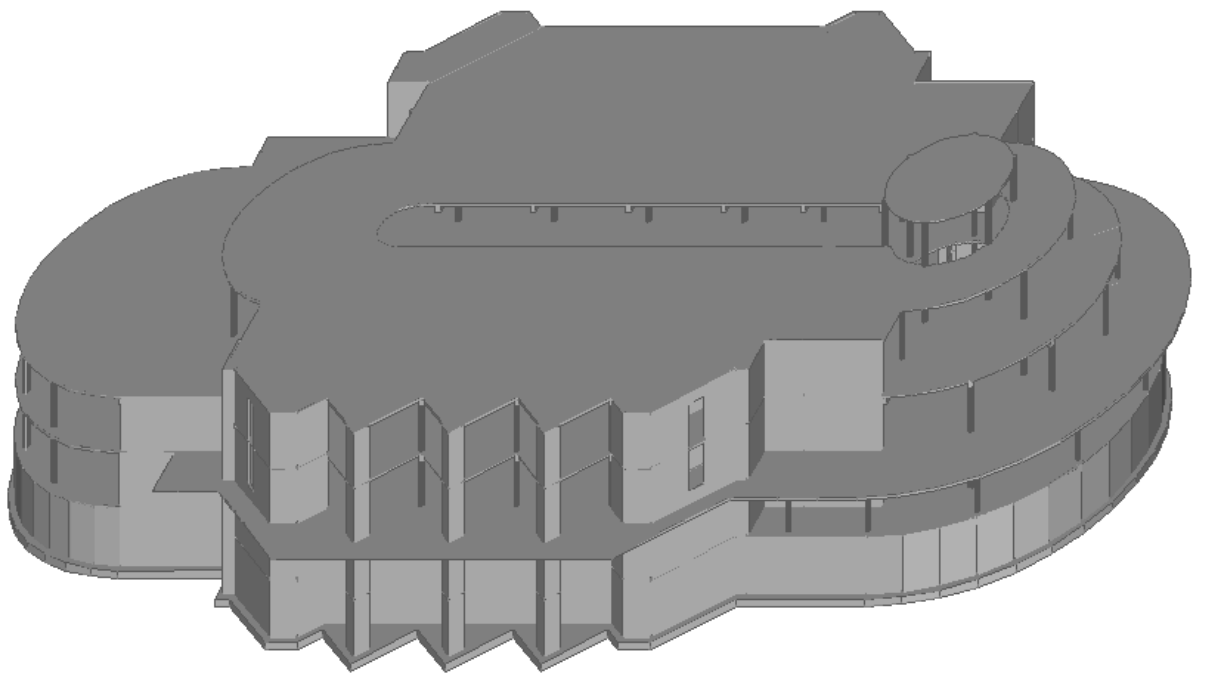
Сформована розрахункова схема будівлі у тривимірному зображенні
